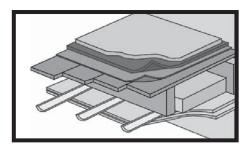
Данная строительная система состоит из деревянного дощатого пола, прибитого к находящейся ниже обрешетке из балок. Укладка на данную систему сравнима с "укладкой на дерево - Рис.39": Соблюдайте приведенные там инструкции.
